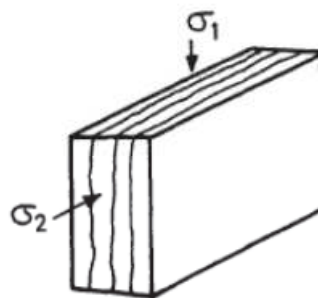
Schéma de fissuration lors d'un essai bi-axial
